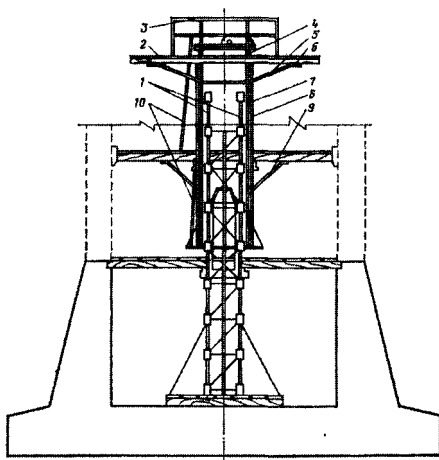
Монтаж верхней части подъемной головки и монтажной площадки:
